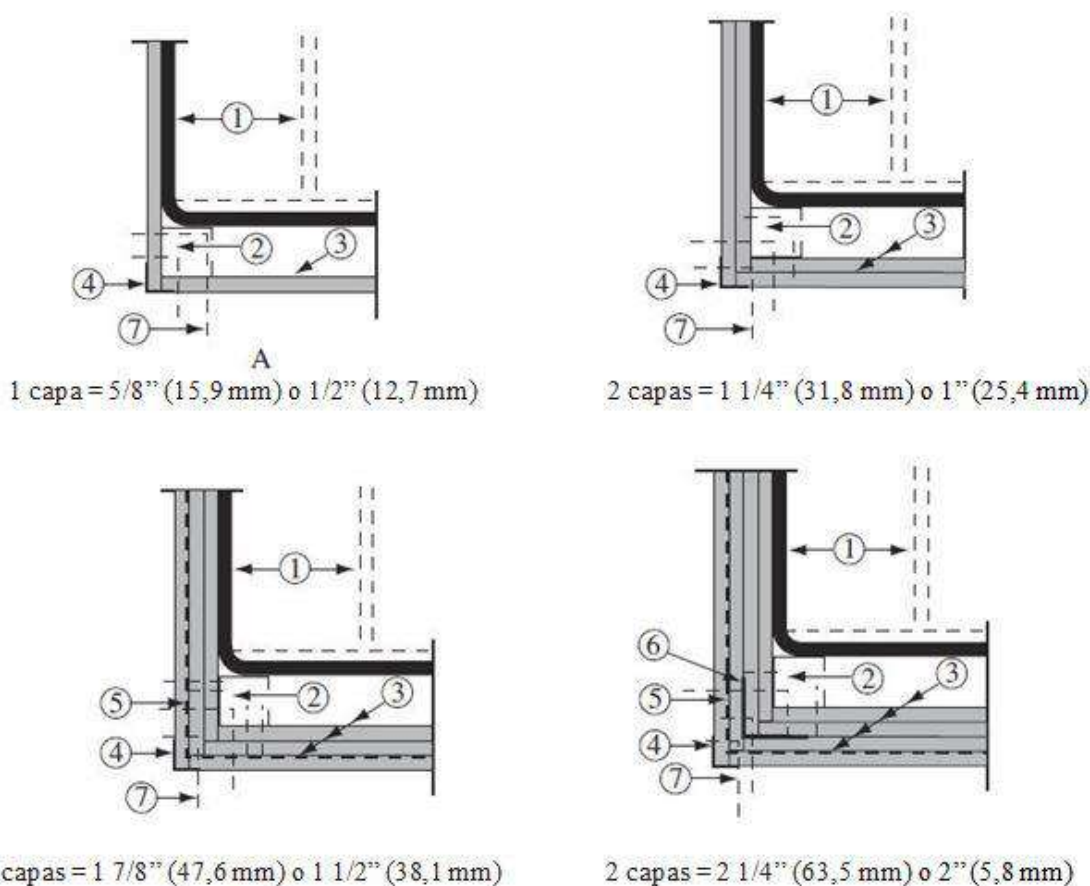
Columnas de acero estructural protegidas por paneles de yeso con sistema de fijación con pernos/tornillos de acero (3 horas o menos)
